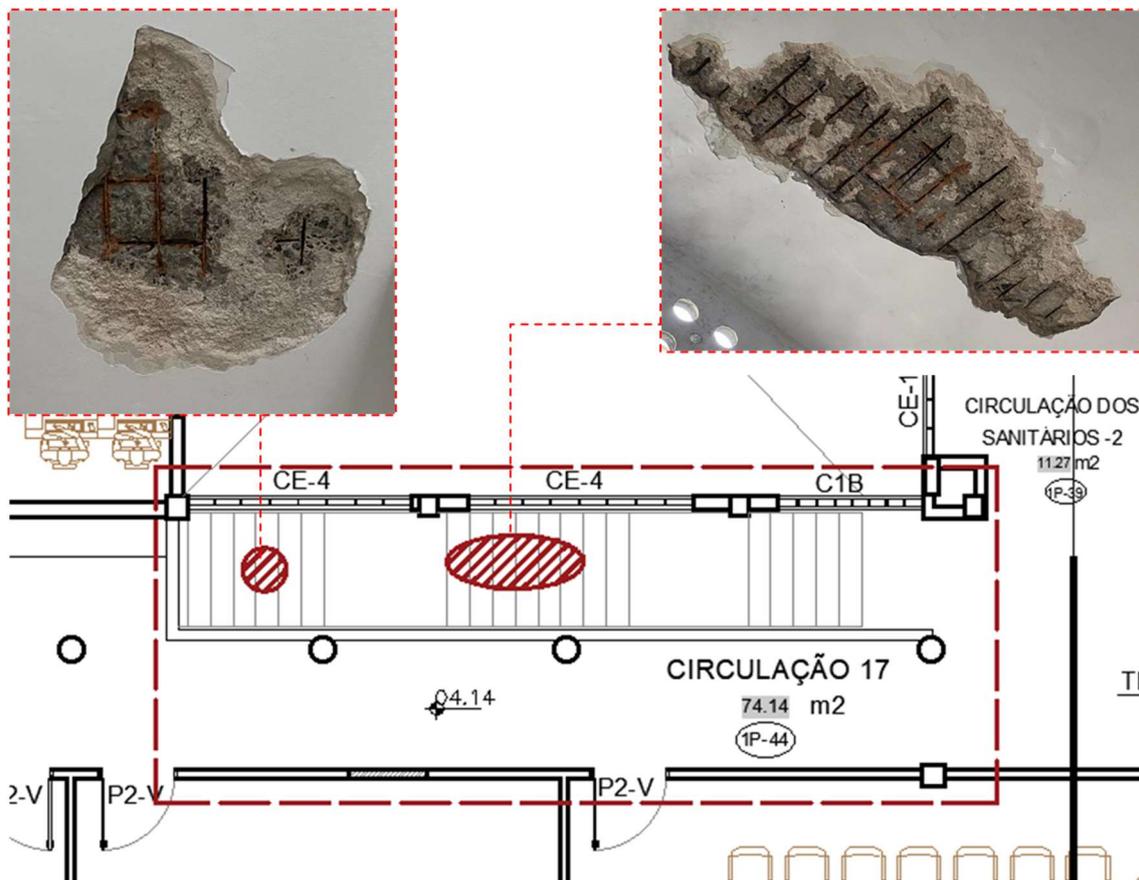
EMEVZ – Plata Baixa do Primeiro Pavimento – Regiões de destaque no item 3.2;
